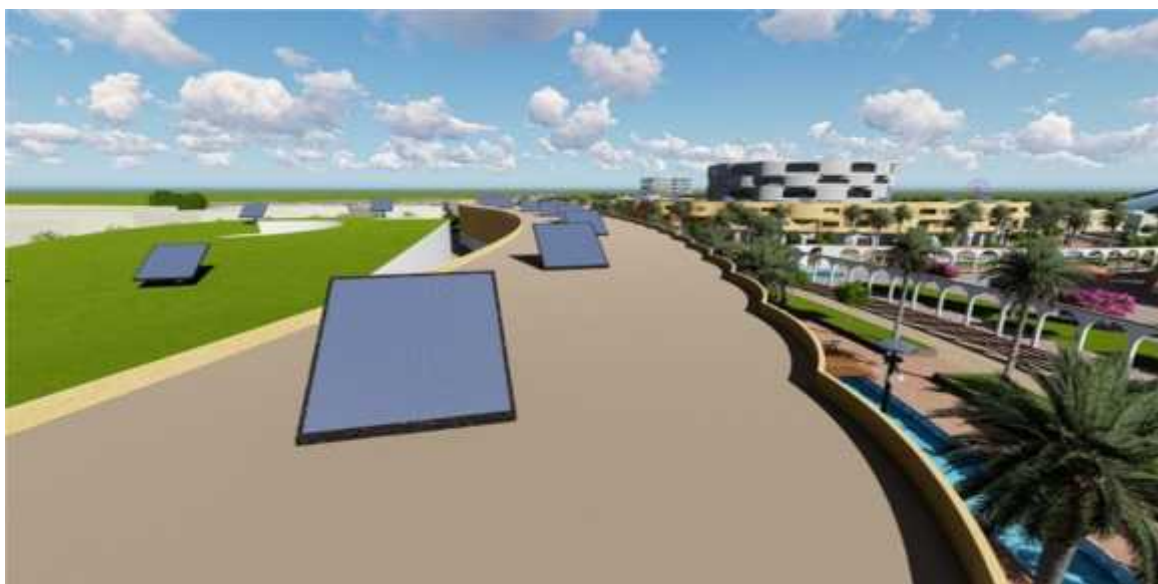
L'installation des panneaux photovoltaïques sur les toitures terrasse des habitats collectifs
